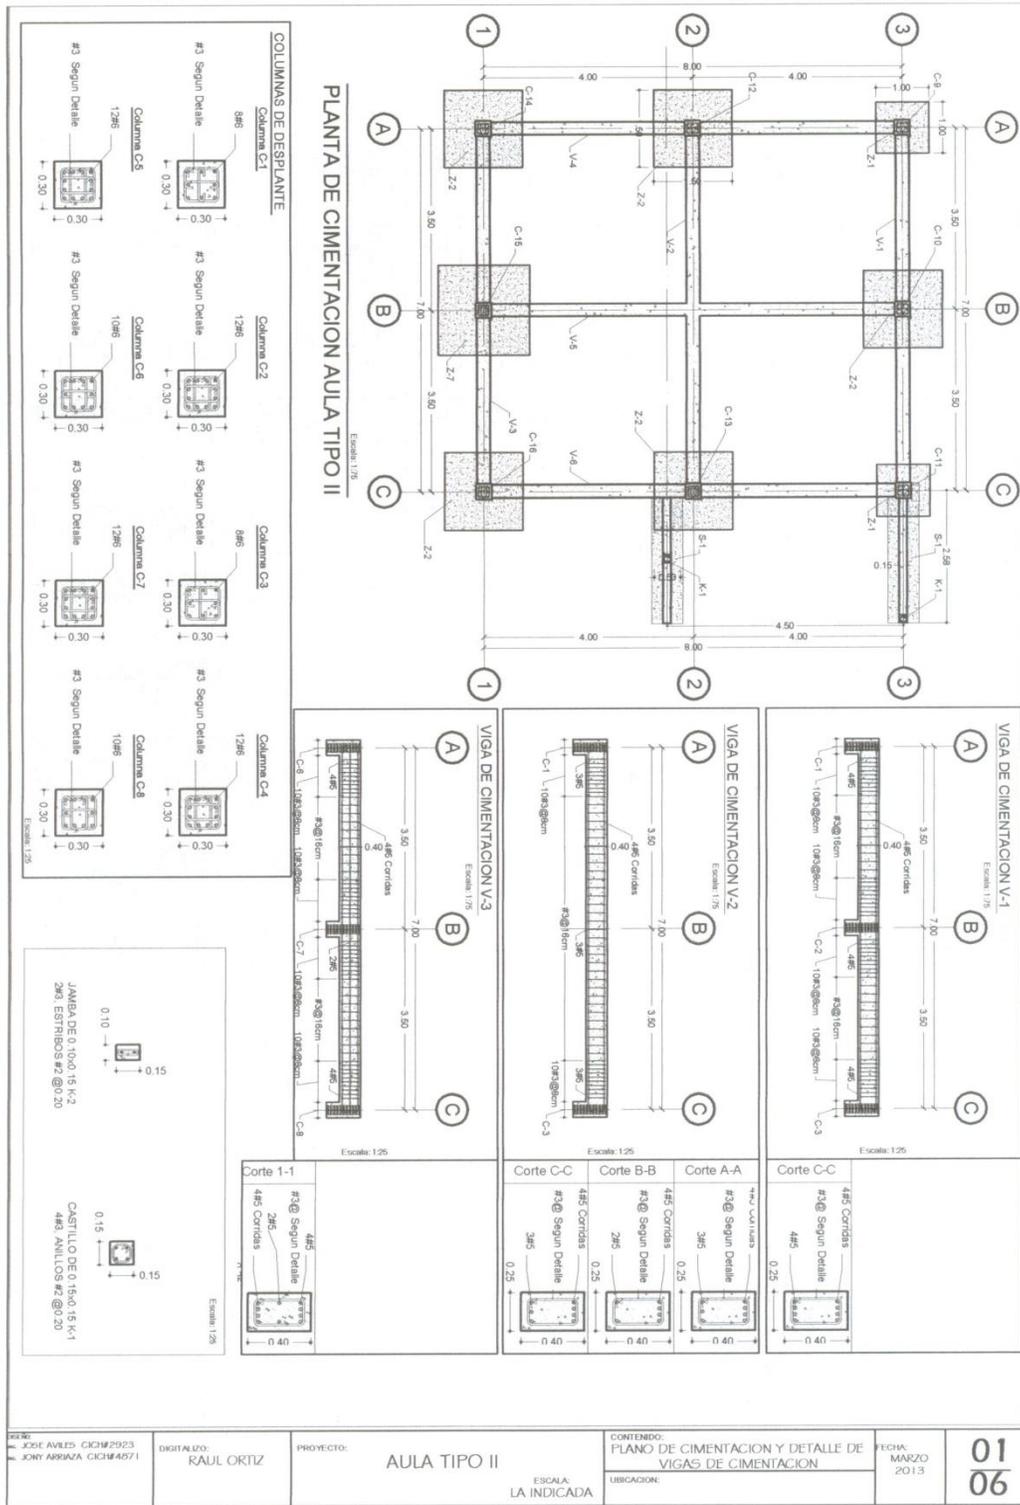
Plano de Cimentaciones Centro Escolar Aula Tipo II Niveles 7X8m
